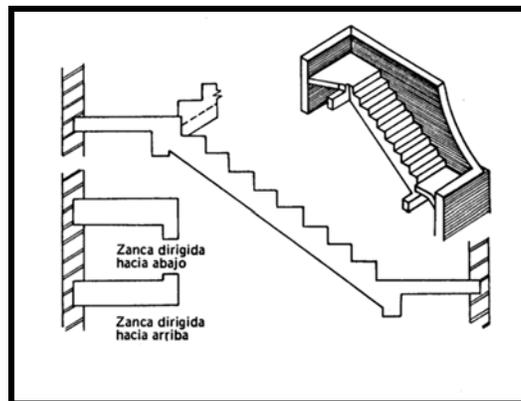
Escalera de hormigón con zancas y vigas soportantes.
